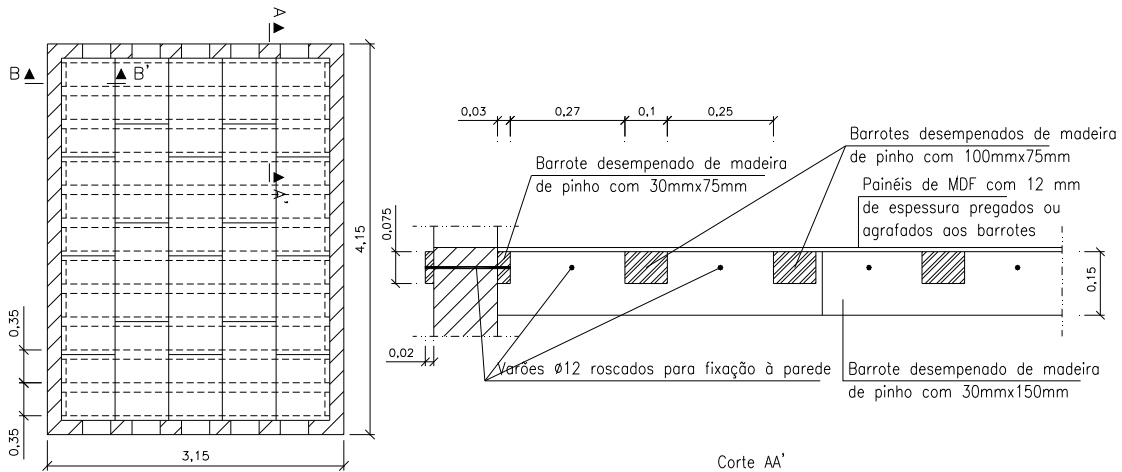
Geometria da estrutura de pavimento utilizado no modelo experimental (Candeias, 2008)
